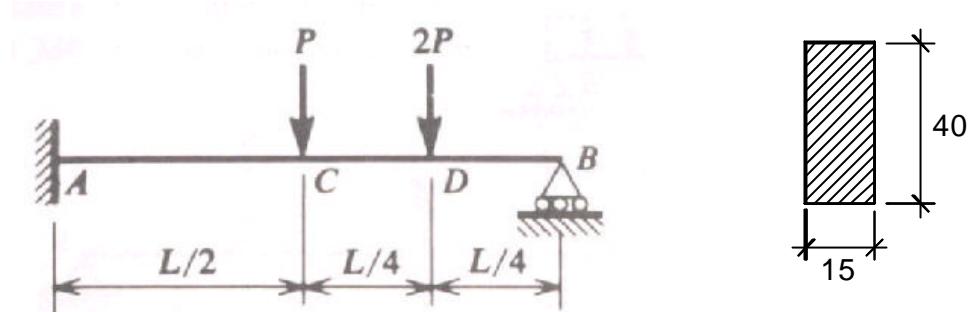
Esquema estrutural da viga do exemplo 4
